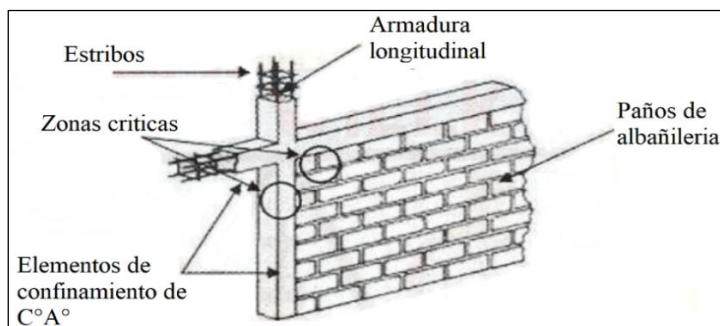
Configuración de un muro de albañilería (Fuente: Giraldo y Ordoñez, 2017)
